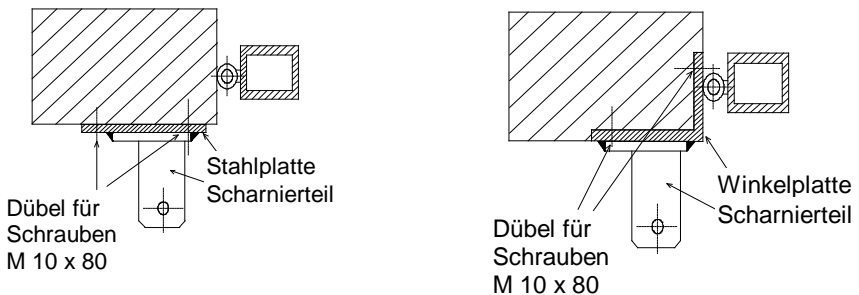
Befestigung des Antriebs am Pfeiler mittels Stahlplatte oder Winkel
